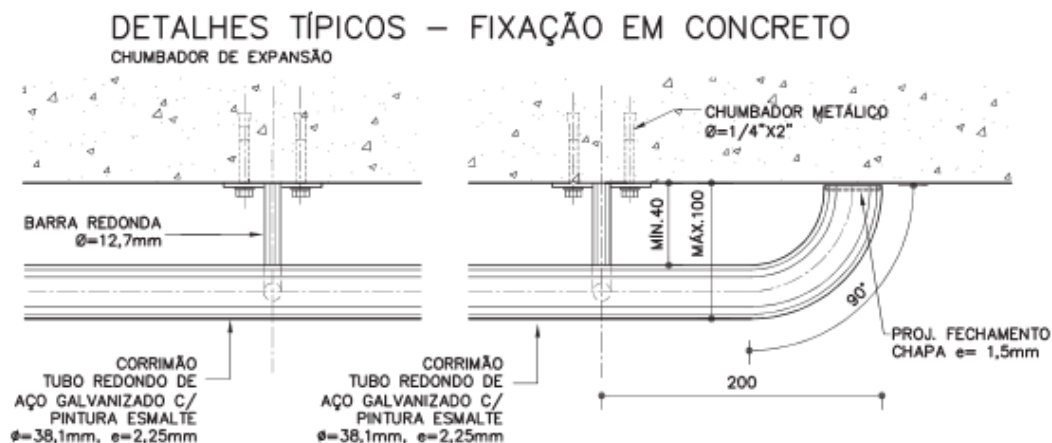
Detalhe Fixação em Concreto (fonte FDE)
